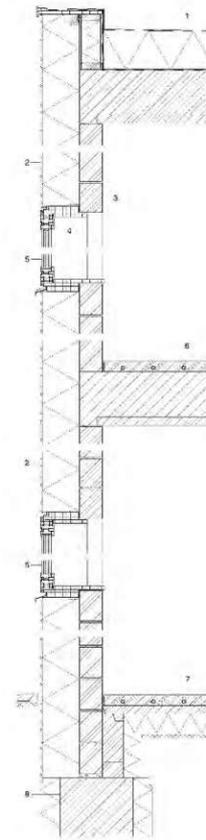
Fassadenschnitt "Mehrgenerationenhaus in Amsterdam" [3]
